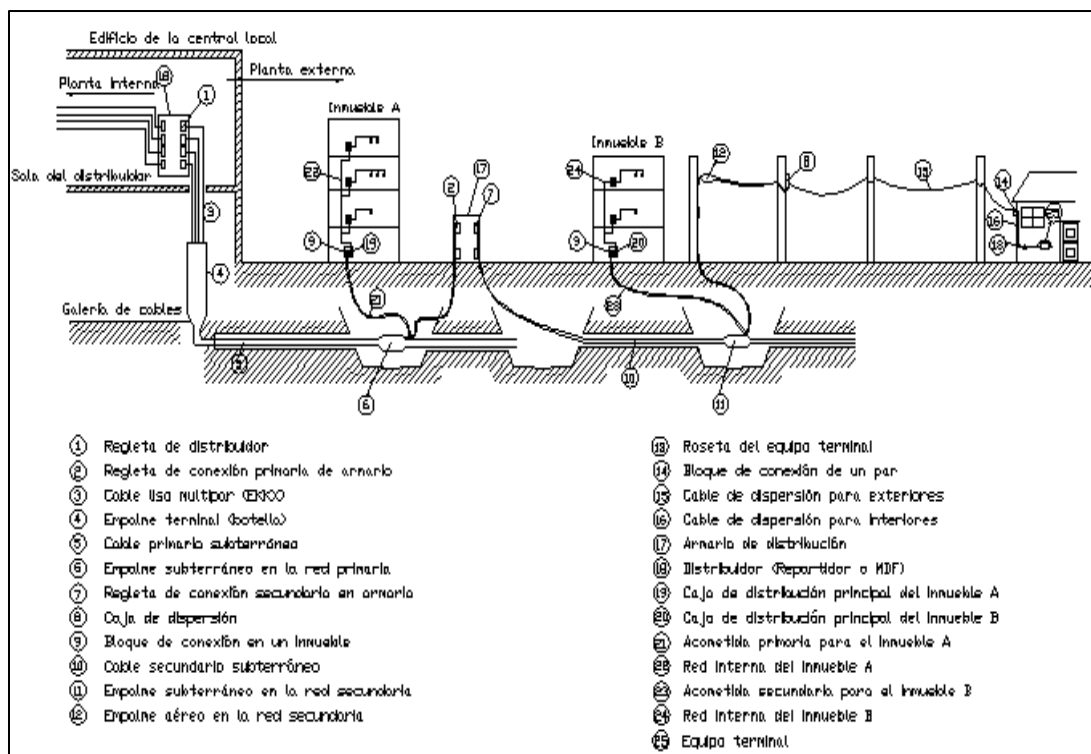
Distribución de una red de cobre planta interna y planta externa
